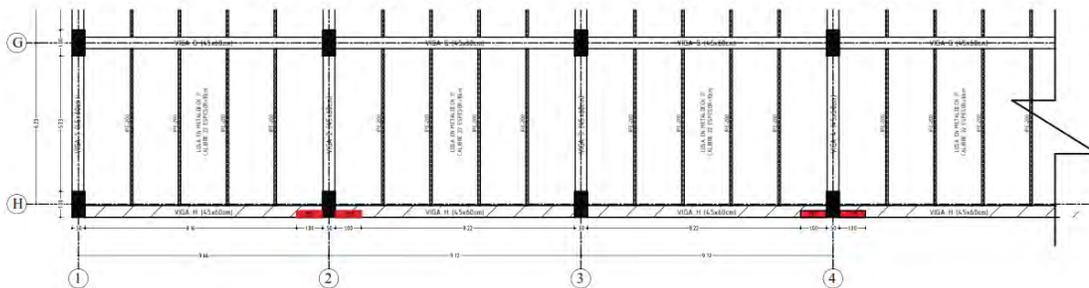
Disposición de la viga H según diseño estructural inicial
